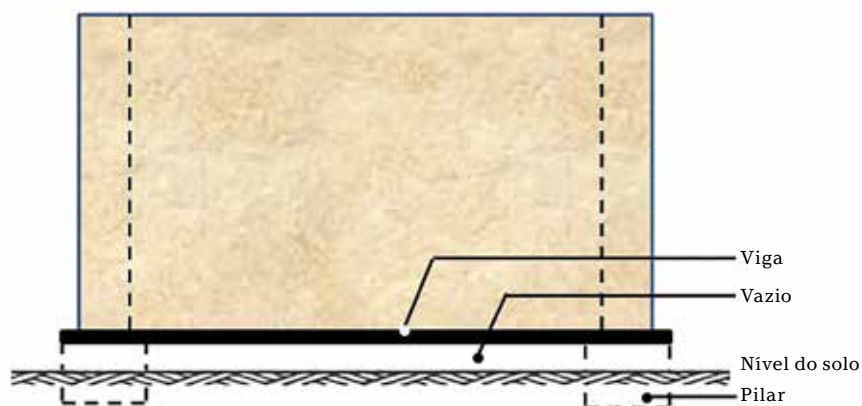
Esquema da construção de fundação no sistema de pilares e vigas.
